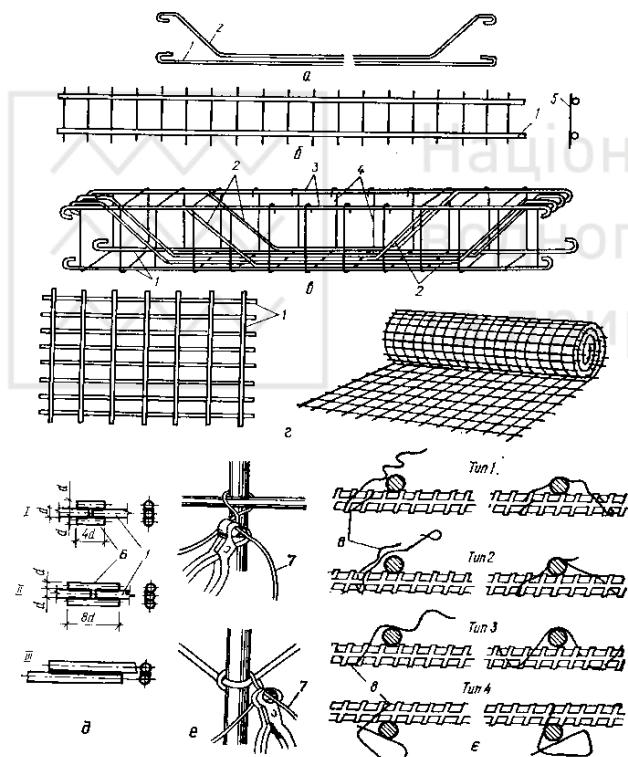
Види арматури та типи з'єднань арматурних стержнів:
